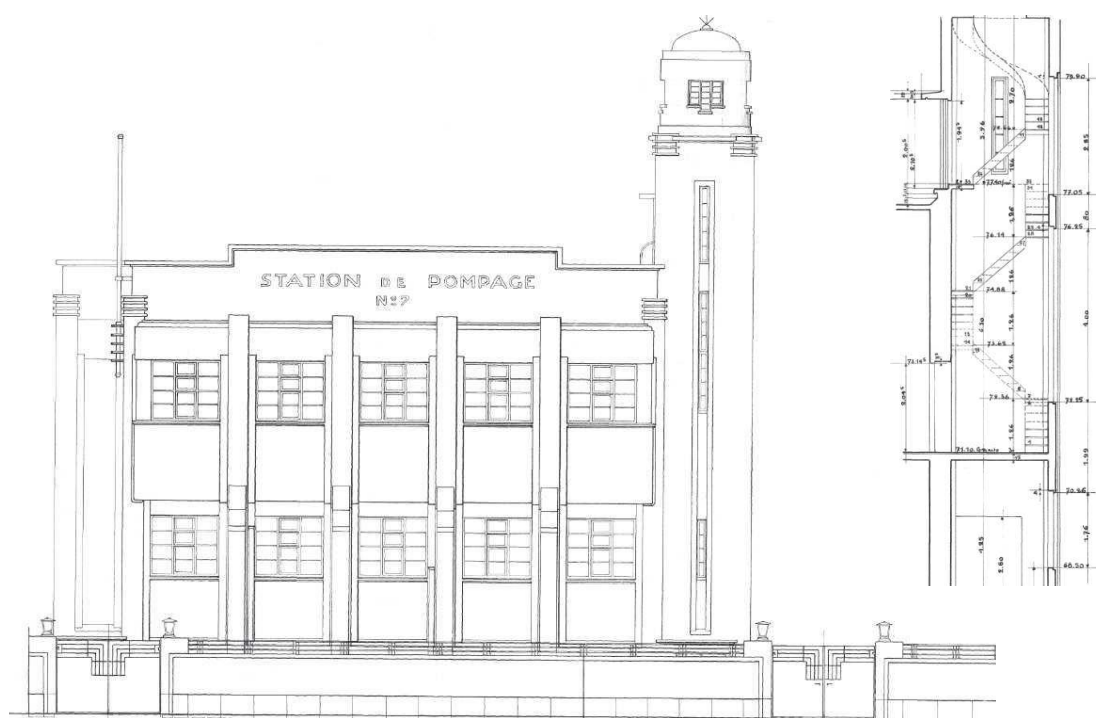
Élévation de la façade Sud et coupe de la tour - ech. 1/200
